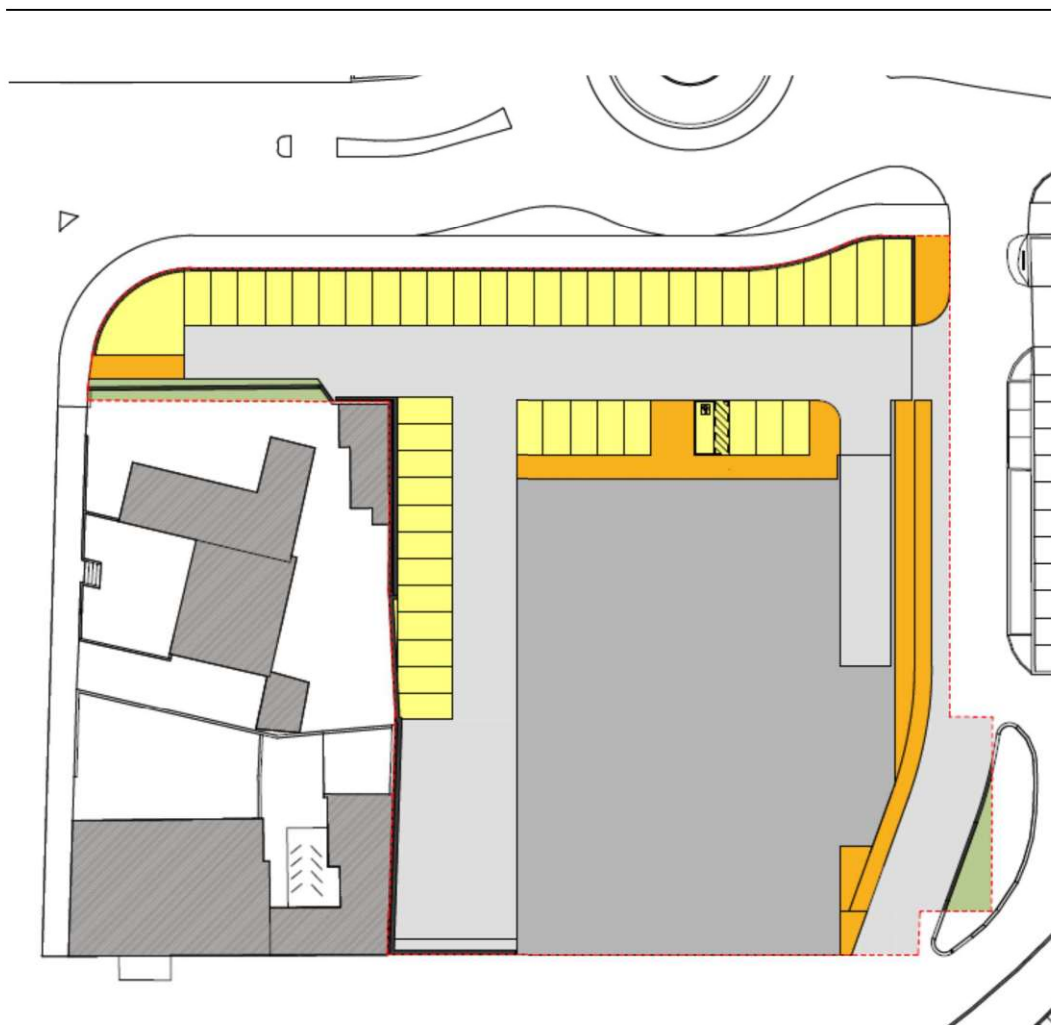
Planimetria dello stato di fatto con indicato in rosso il perimetro del lotto 2
